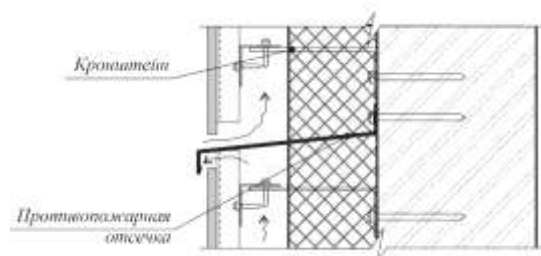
Противопожарные мероприятия при устройстве навесных фасадных систем:
